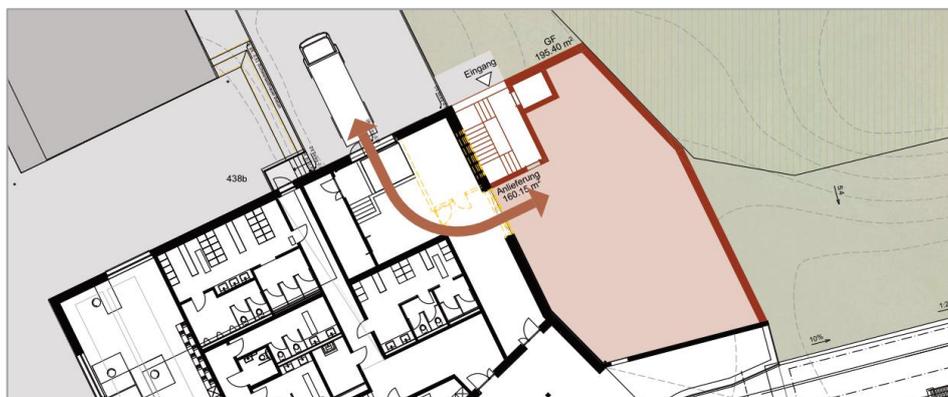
Grundriss Vergrößerung Anlieferung, Ritter Schumacher AG
